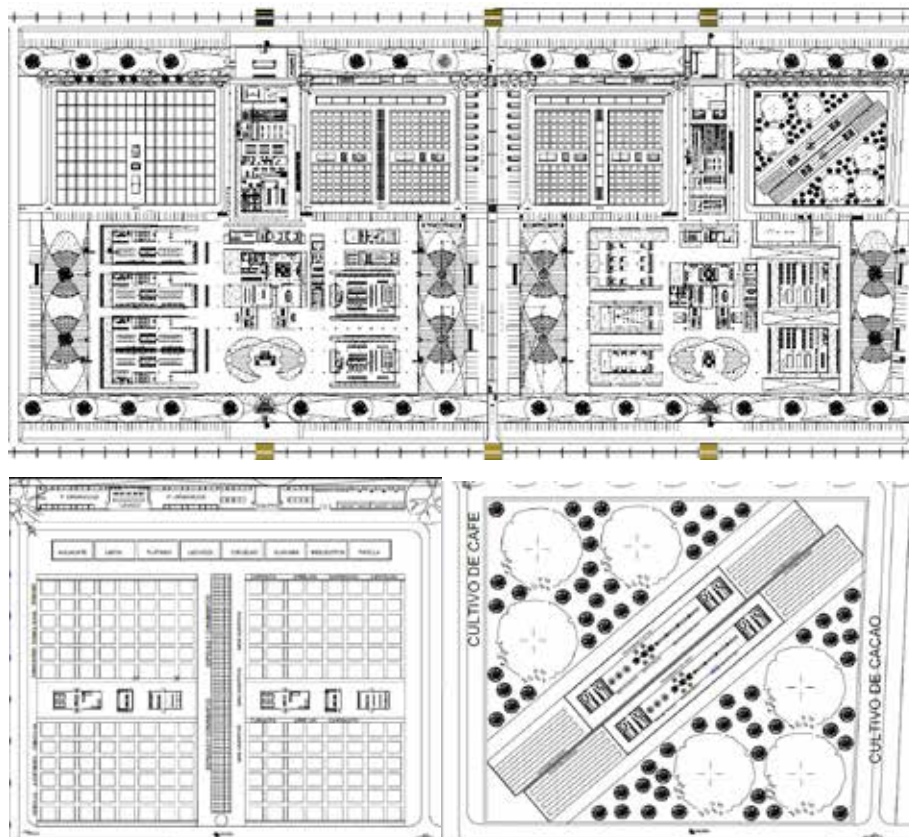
Planta Baja-Conjunto. Fuente: Schaverin (2021)
